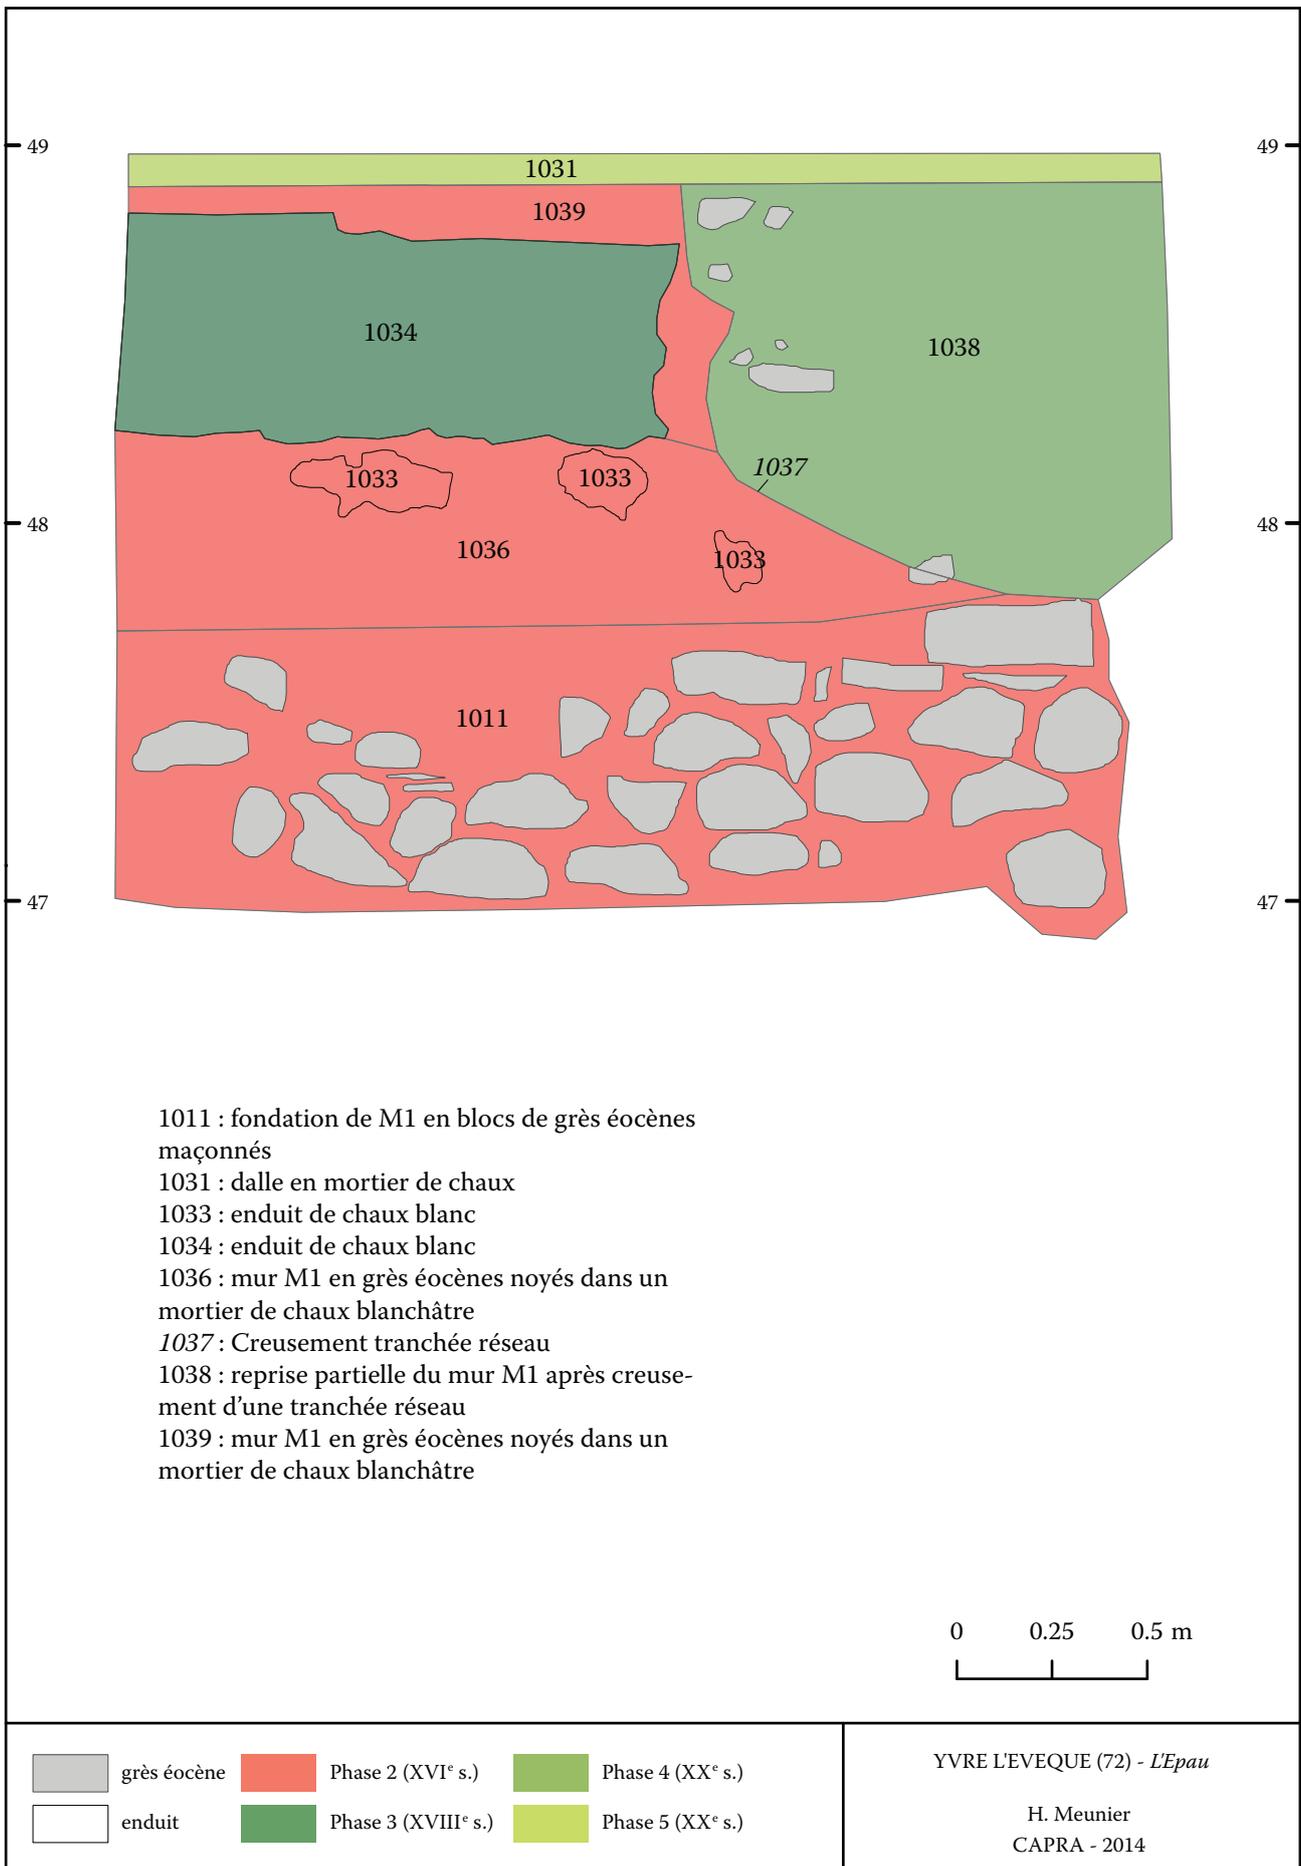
Coupe 2 (cf. plan fig. 5)
